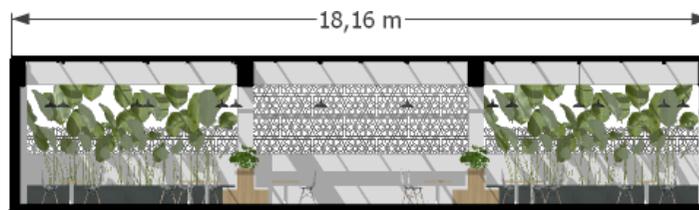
Detail ruang komunal (Hasil Rancangan, 2021)
